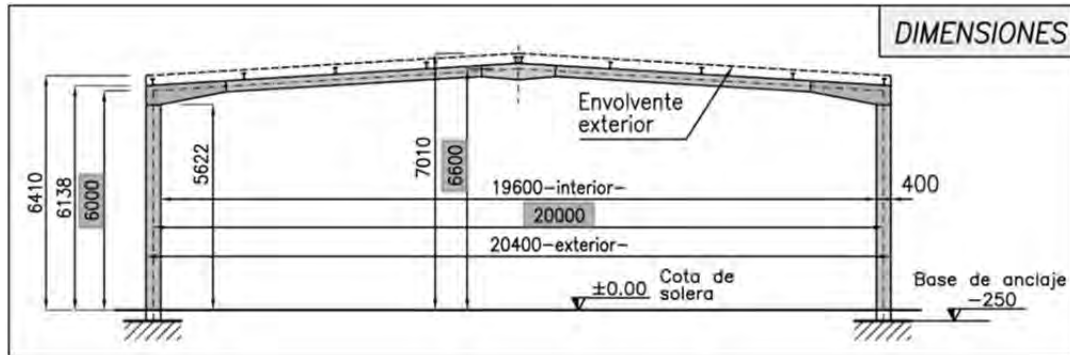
Dimensiones geométricas estructurales y constructivas de un pórtico (mm)
